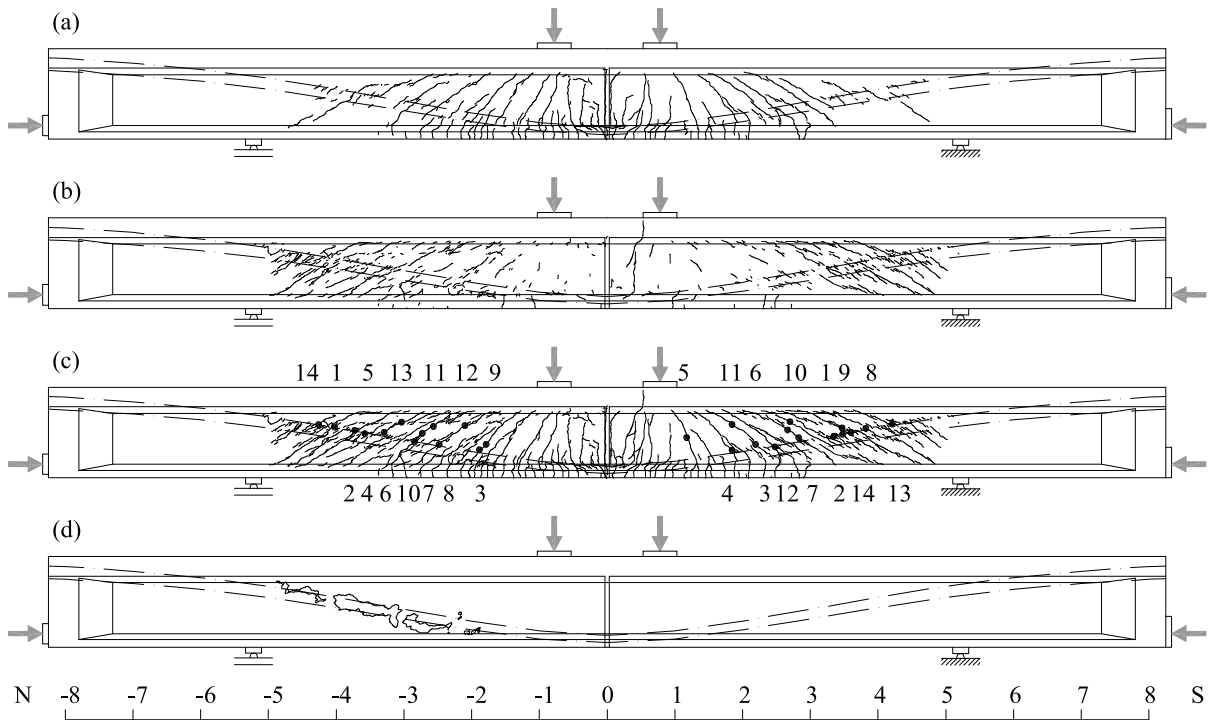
Fissuration de l'essai SH3 : (a) palier 3 (b) fissuration additionnelle entre le palier 3 et la rupture (c) rupture (d) éclatement du béton immédiatement après la rupture
